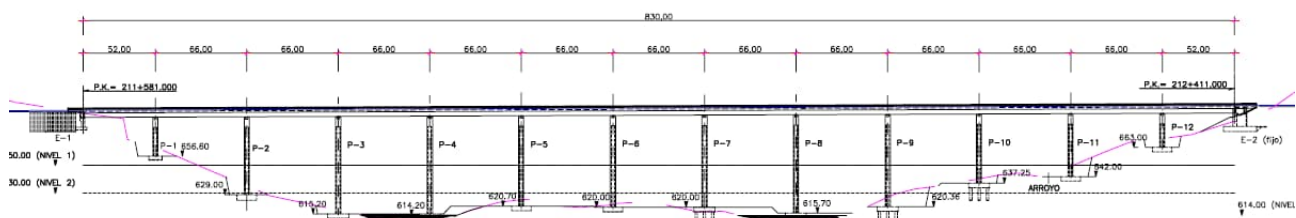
Alzado de la estructura. Fuente: Proyecto constructivo.
